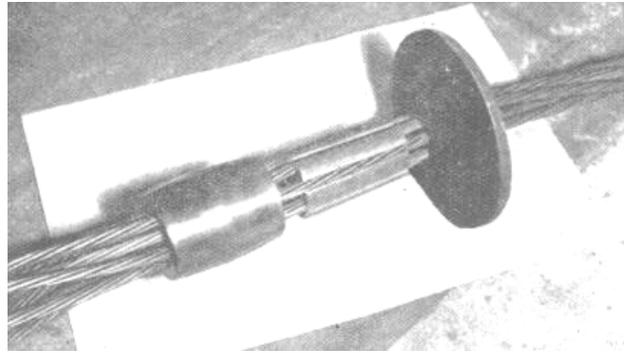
Arreglo de los cables para el sistema SGTM.
